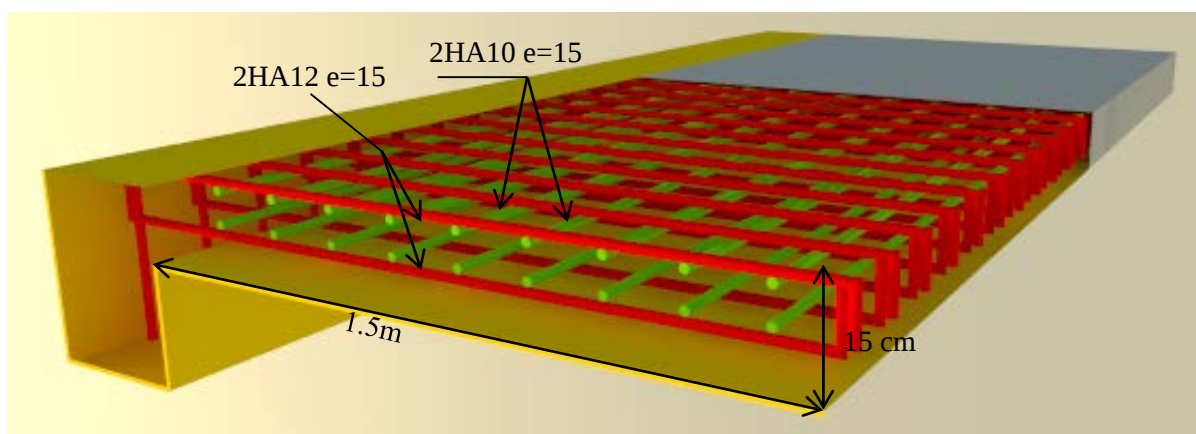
Schémas de ferrailage de balcon en 3D.
